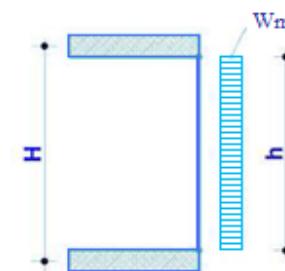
Расчетная схема стойки каркаса стены при воздействии ветровой нагрузки
